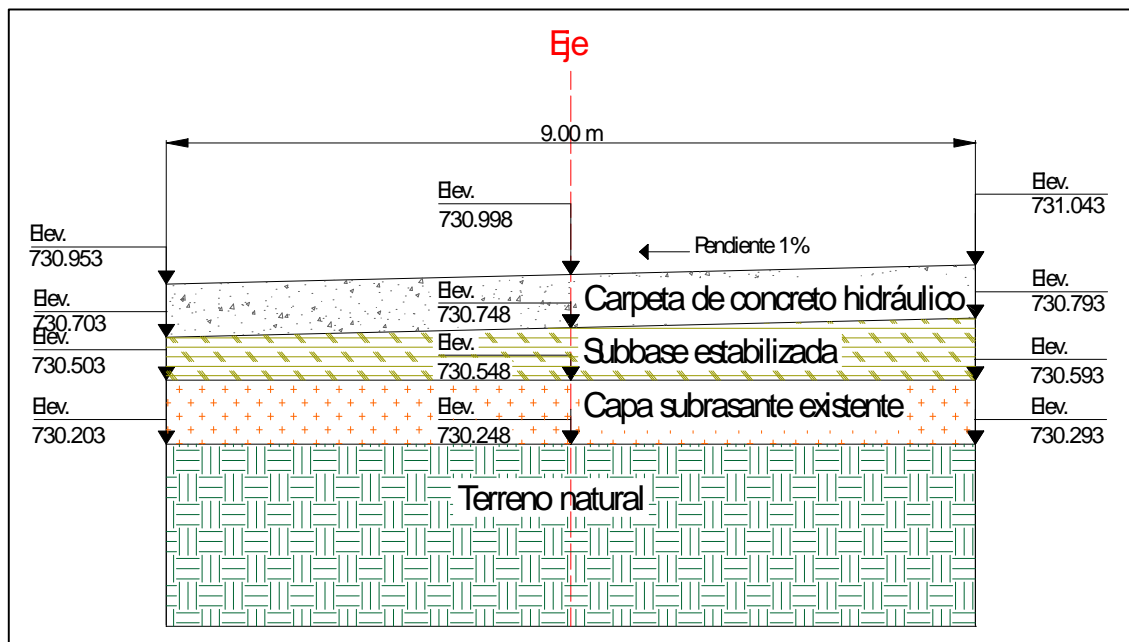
La figura muestra una sección transversal típica del pavimento de concreto con sus respectivas elevaciones de cada una de las capas.
